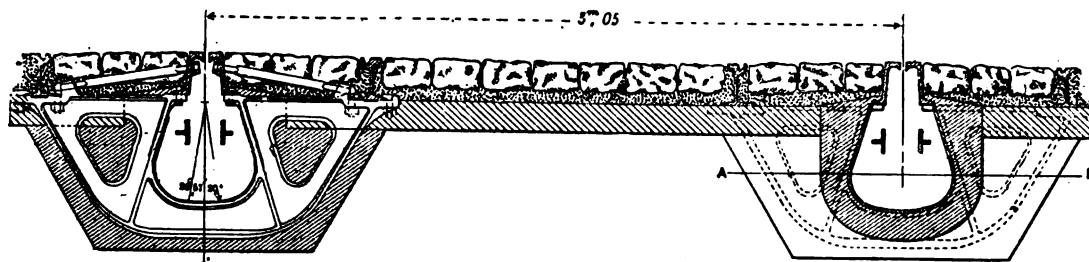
Canalisations souterraines du Metropolitan Railway de Washington, coupe transversale.
